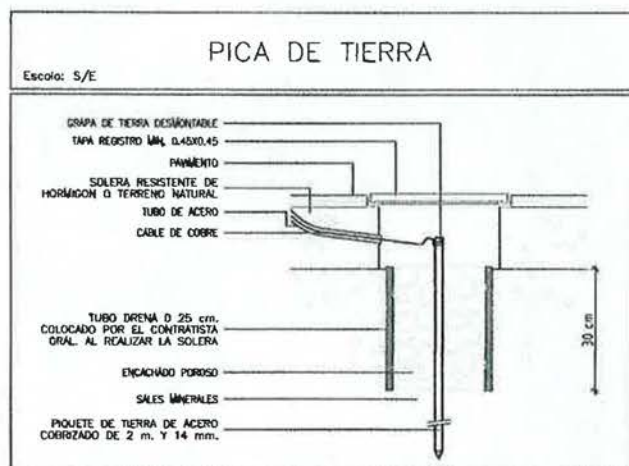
Ejemplo del plano de detalle para la instalación de una pica de tierra en arqueta.
